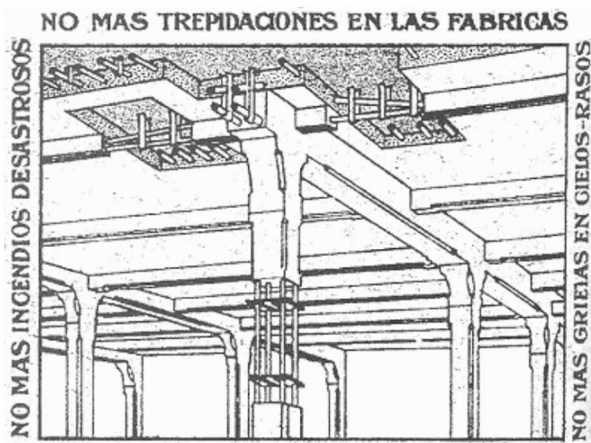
Publicidad de la época sobre el sistema de forjado y pilares de hormigón armado patentado de Hennebique [1].
